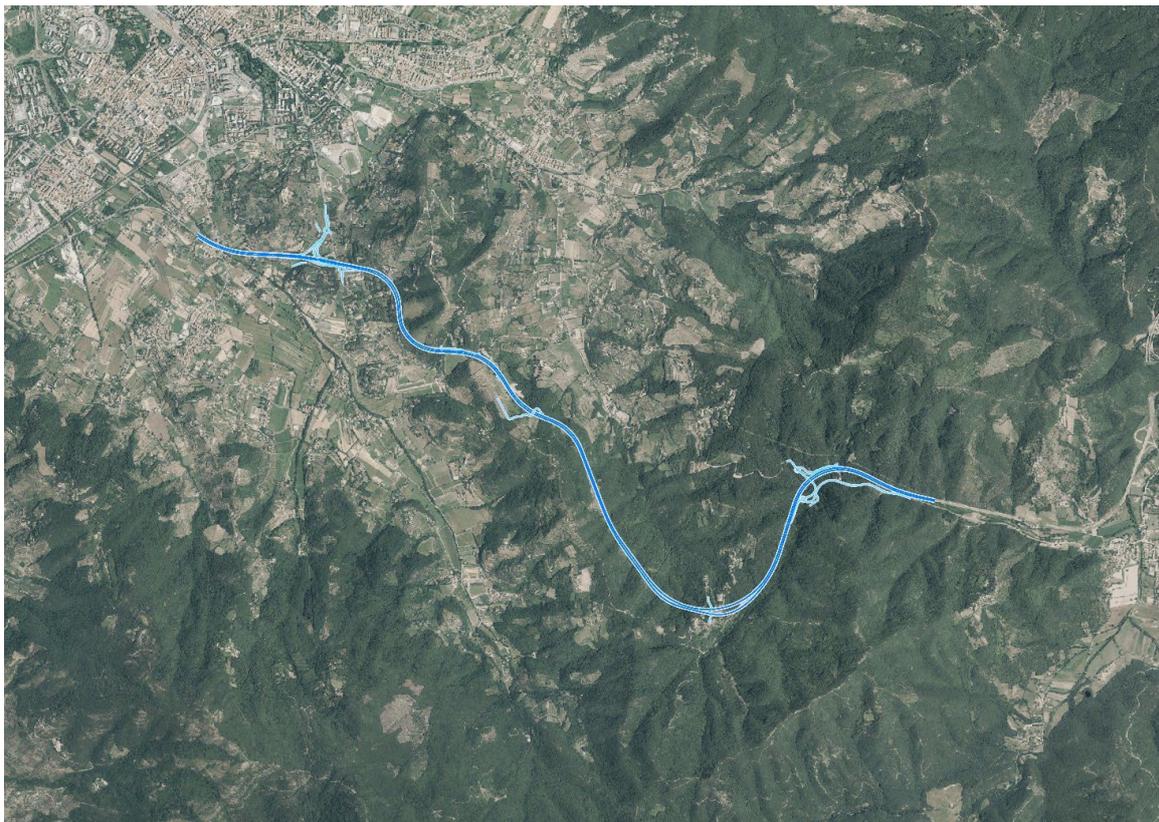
Individuazione tramite ortofoto del tracciato del progetto di mitigazione
